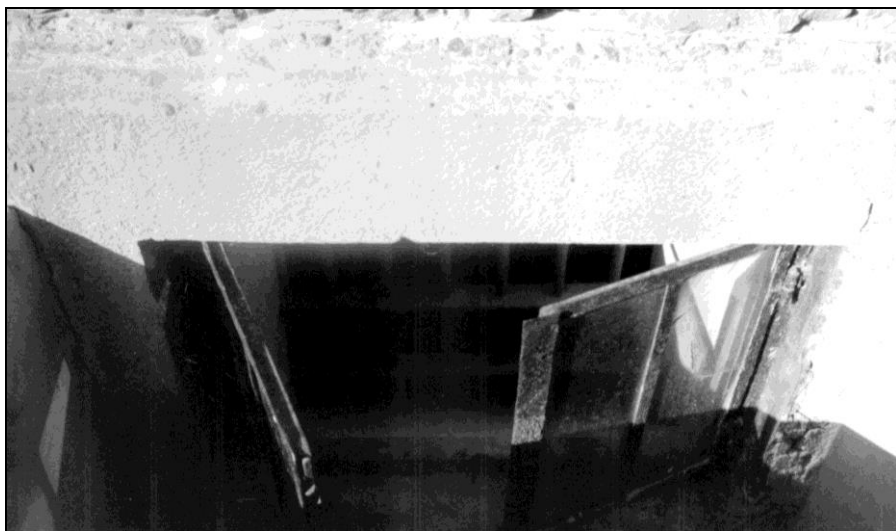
Block 11, außen, Nordost-Mauer, Fenster einer Bunkerzelle, umgeben von einer Betonmauer.
